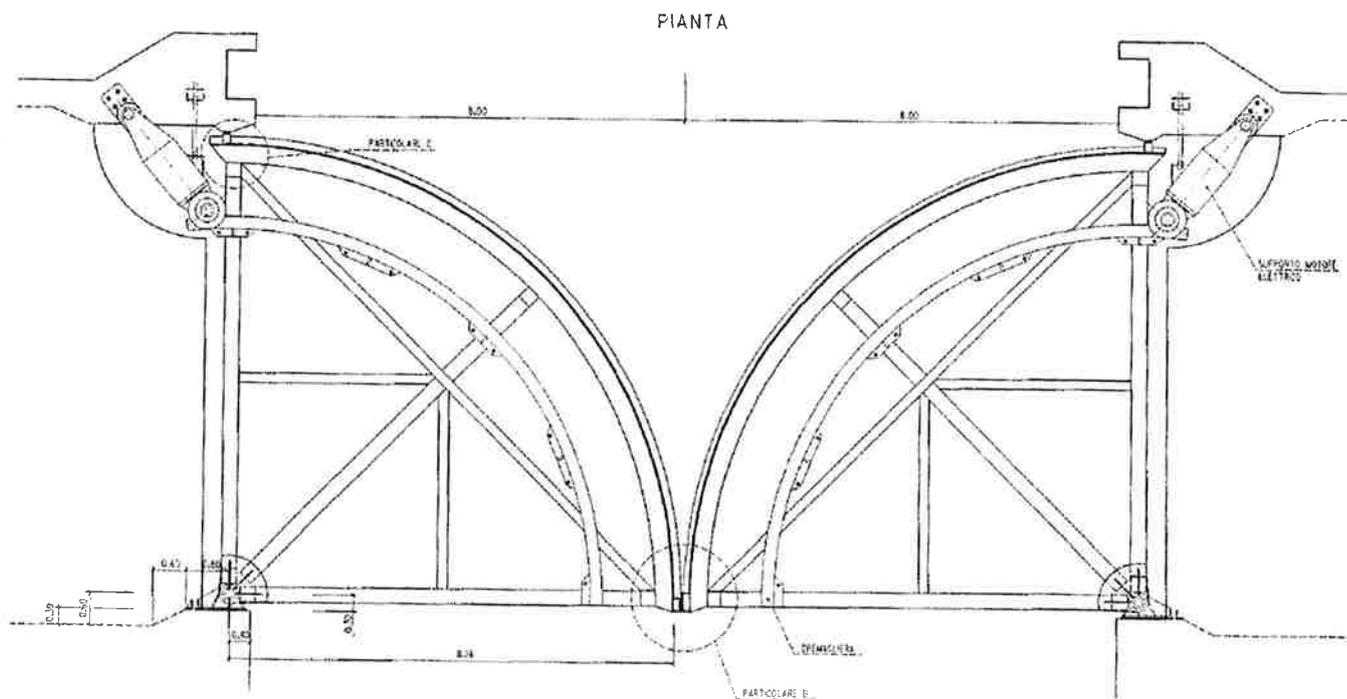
PIANTE PORTE CONCHE DI CHIOGGIA PROGETTO DEFINITIVO
